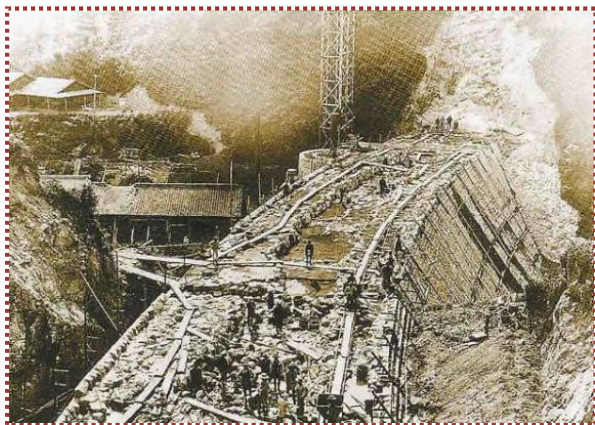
明治36年6月 粗石モルタル造堰堤の施工状況
